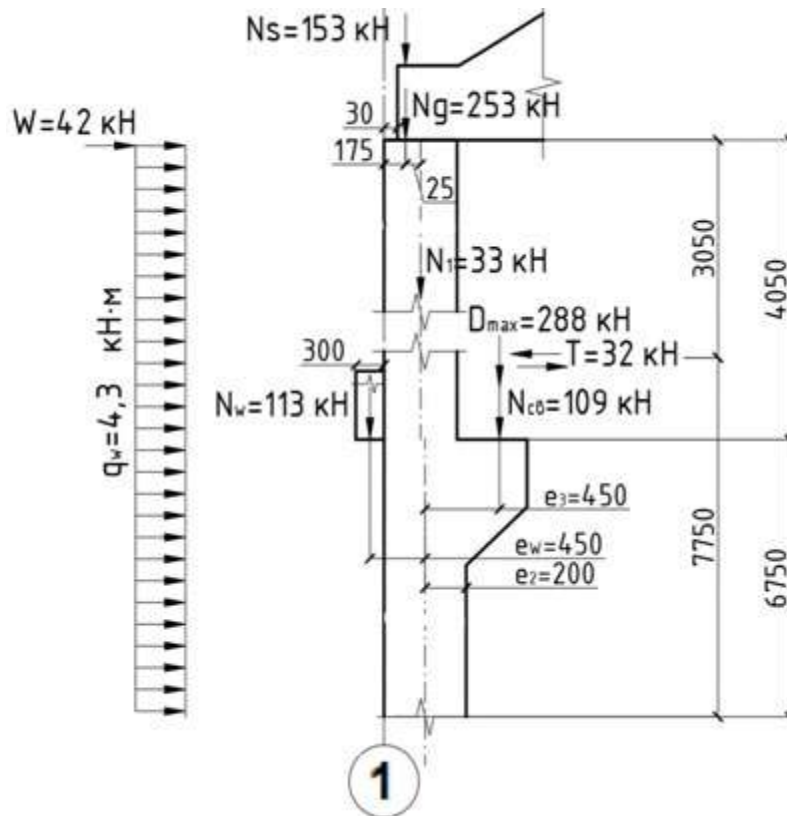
Розрахункова схема колои з прикаденими навантаеннями
